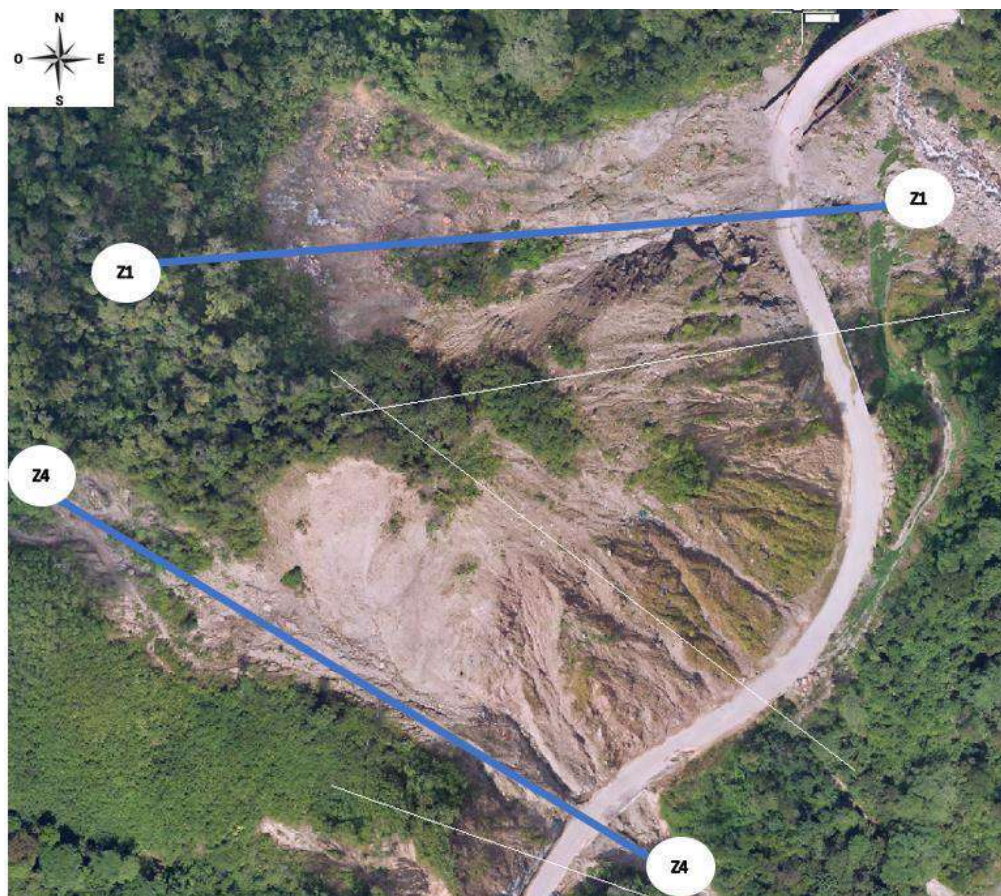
Vista en planta de las secciones analizadas en el talud La Honda.
